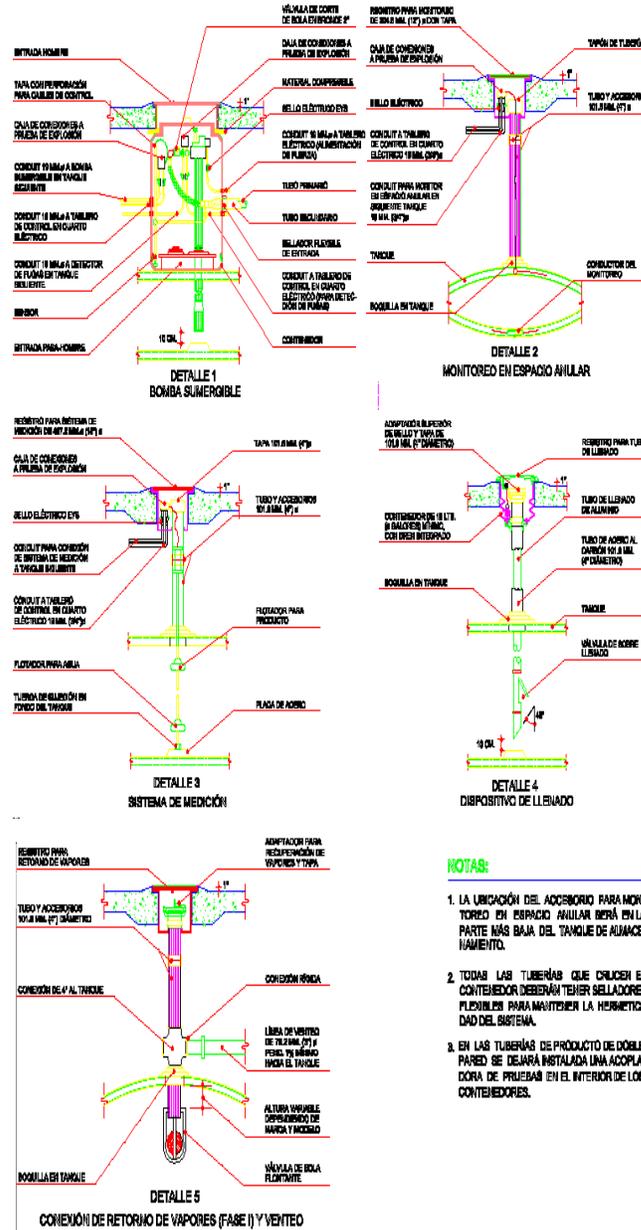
Detalles de accesorios para tanques de almacenamiento.
